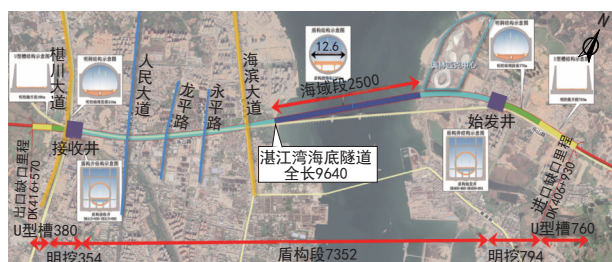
湛江湾海底隧道平面位置示意图(单位:m)
